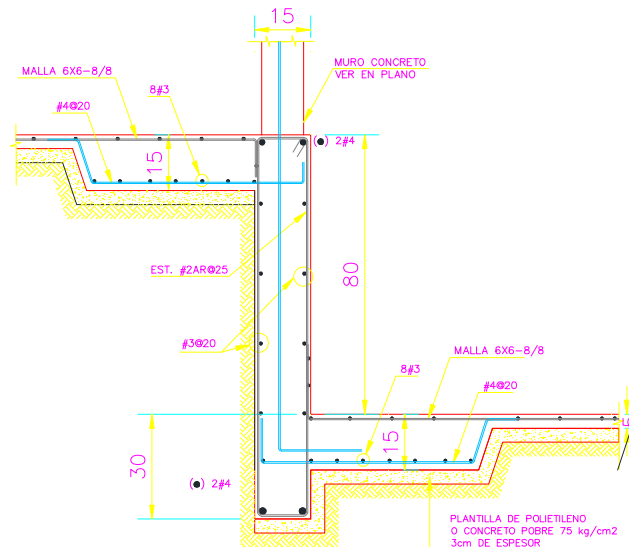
Muro de concreto y zapatas perpendiculares en desnivel
